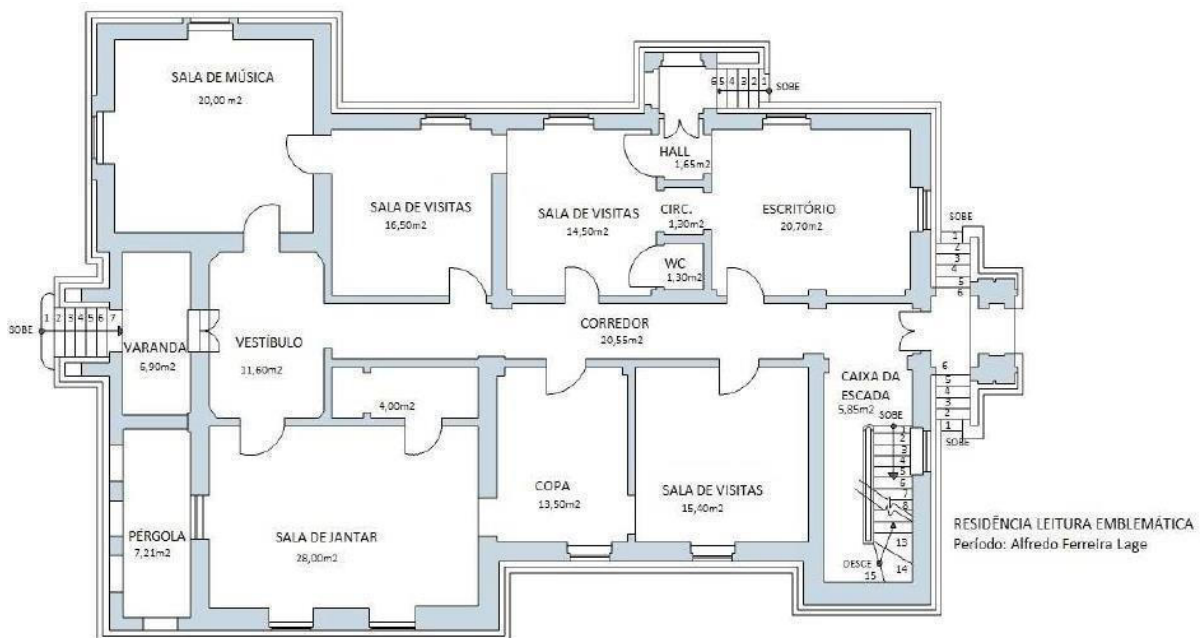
Leitura Emblemática do Pavimento 2, Período Alfredo Ferreira Lage. Fonte: DAT/MMP (adaptado pela autora)
